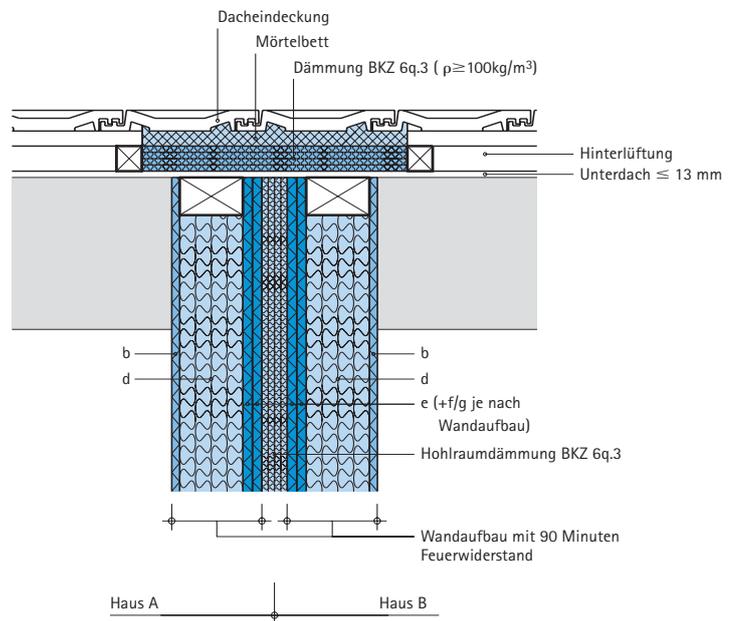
Dachkonstruktion schliesst an Brandmuerkonstruktion an
